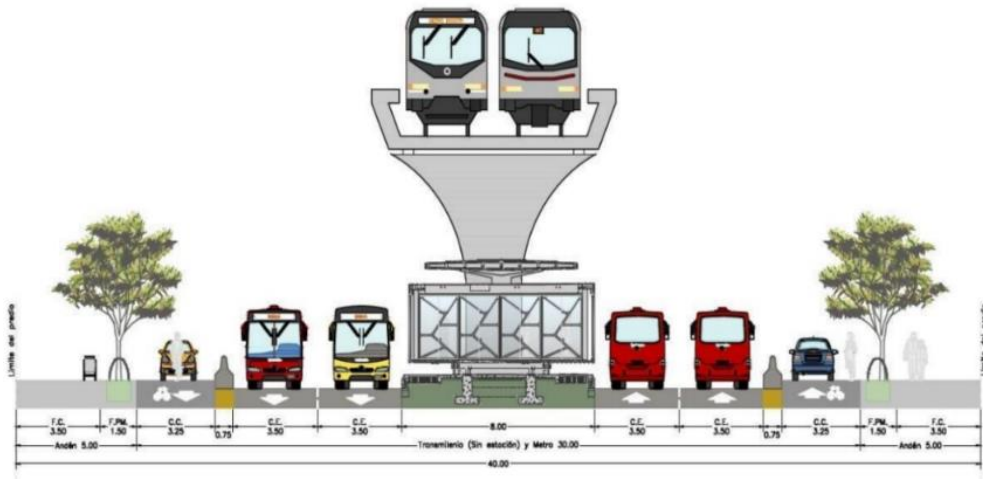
Perfil Avenida Caracas Entre Calle 26 y Calle 72 Actual
